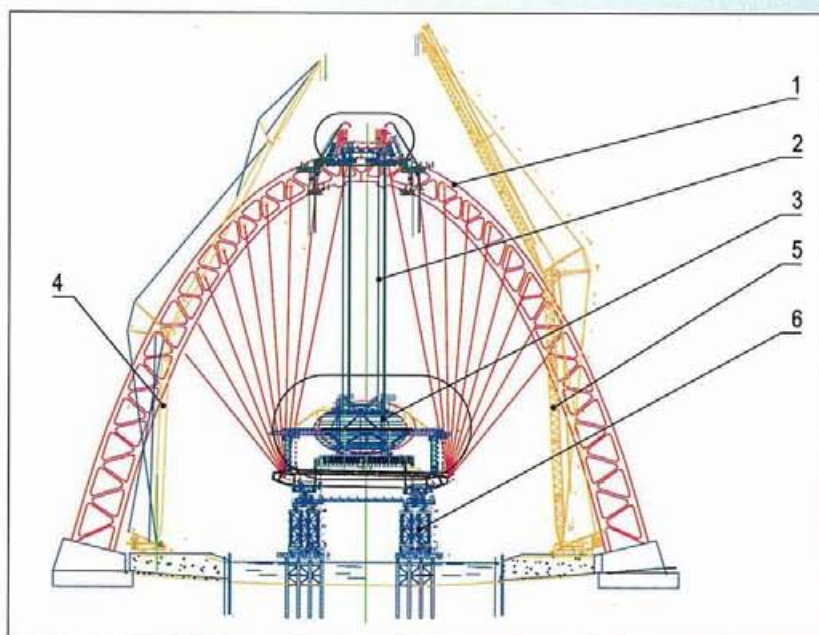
Общая схема организации работ: 1 – арочный пилон; 2 – подъемные канаты; 3 – смотровая площадка; 4 – монтажный кран Liebherr 1350/1 SWF (для подачи элементов); 5 – монтажный кран Liebherr 1400/2 SLN (для подачи элементов); 6 – вспомогательная опора
